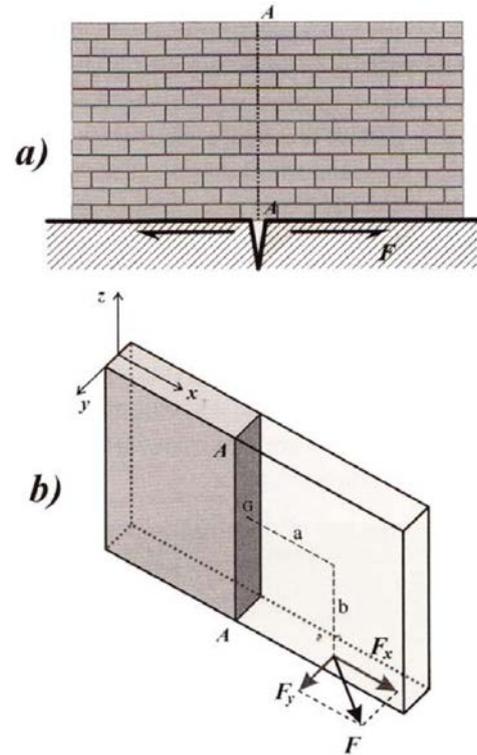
Lesione di un paramento murario di fondazione sollecitato nel piano. Da Cucco F., *Statica e consolidamento degli edifici storici*, Grafill, Palermo, 2008.
